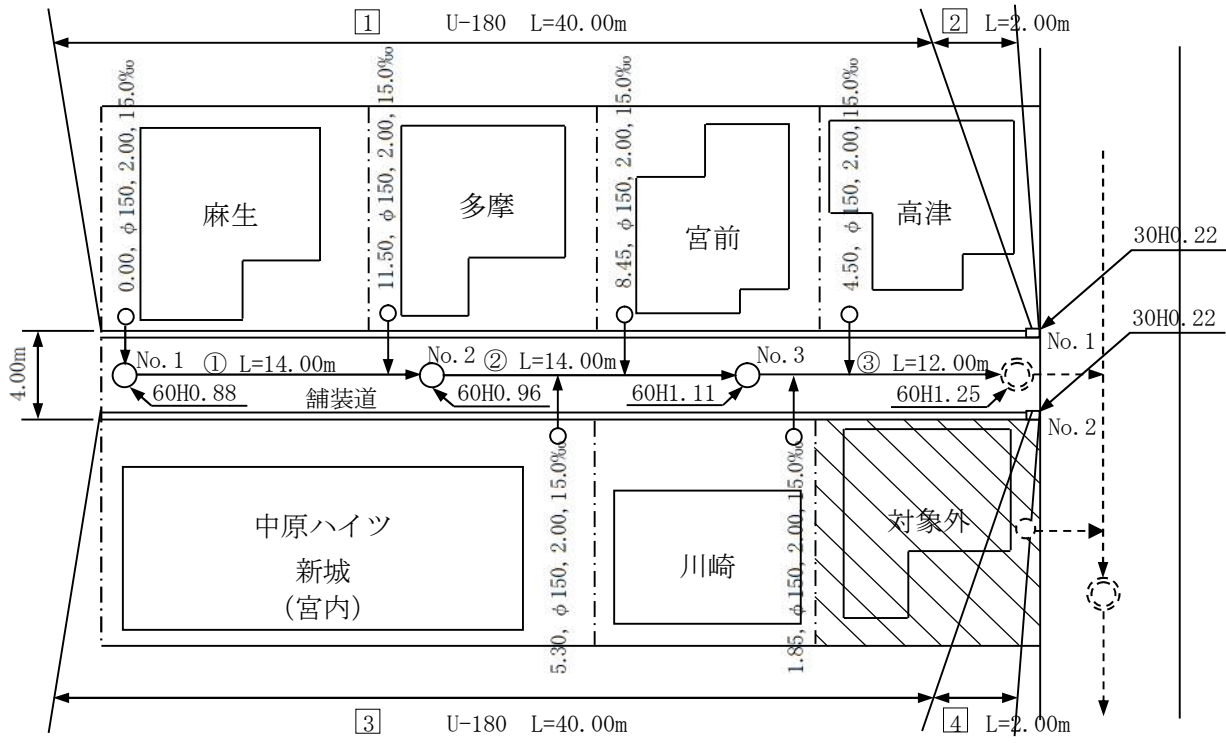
(a) 平面図 (分流式) 縮尺: 1/300
